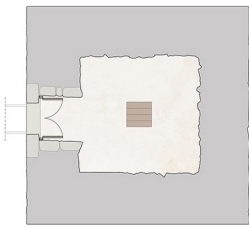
248 Plantas con forjados intervención. Javier Hidalgo Mora.
